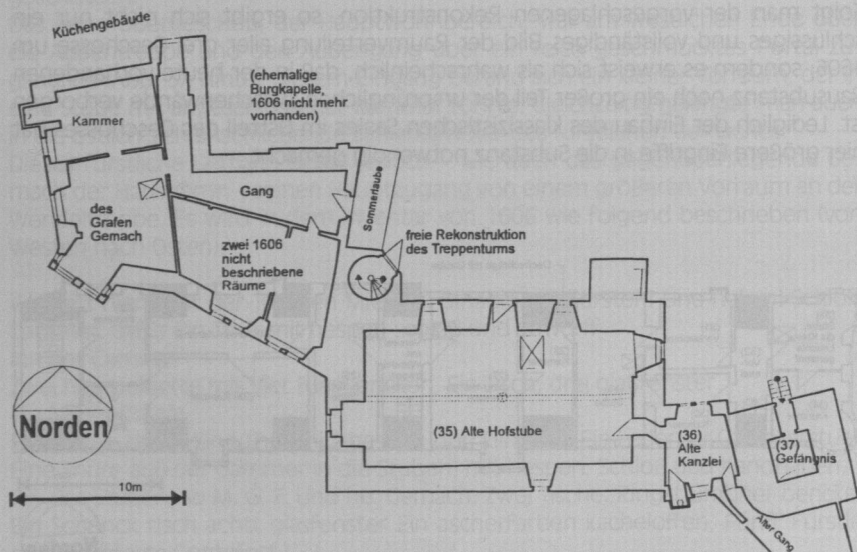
Krummer Bau, Altes Haus und Blauer Turm. Grundriß des Erdgeschosses. Rekonstruktion des Zustandes 1606
